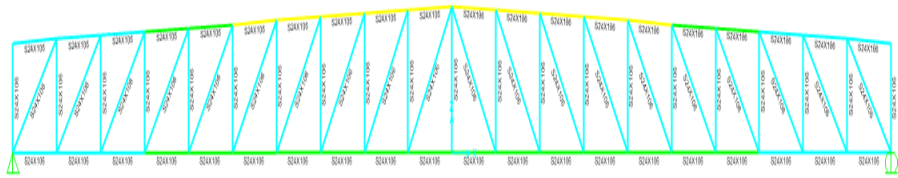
Chequeo de la estructura con la sección S24x106.
